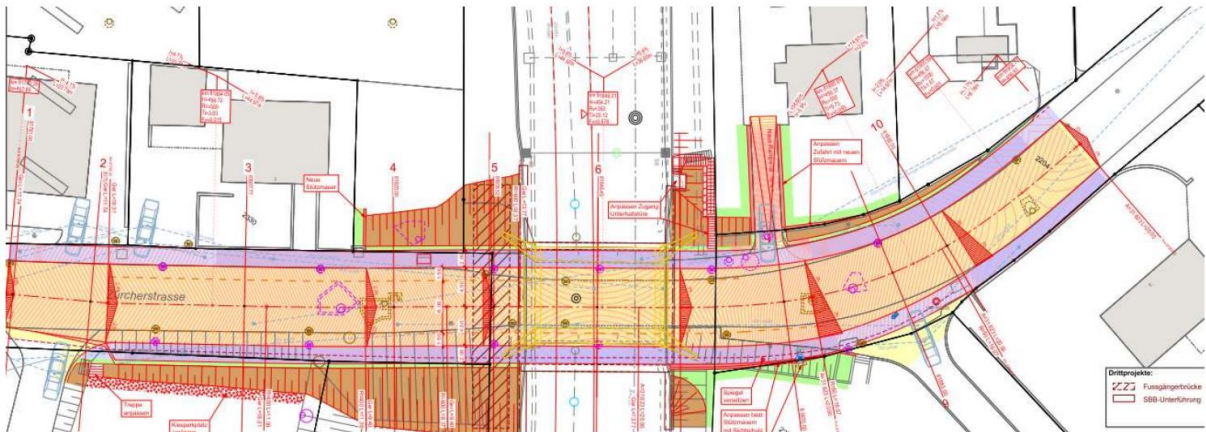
Grundriss Strassenverbreiterung
